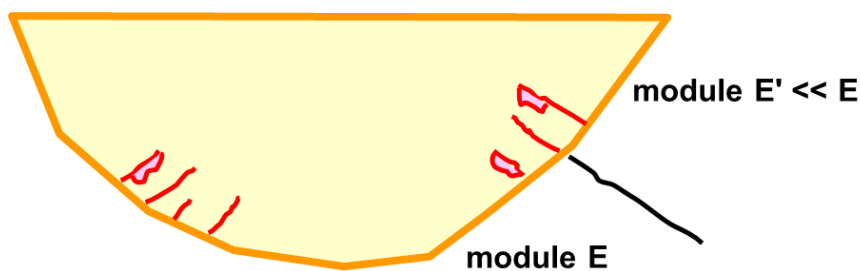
Fissuration par hétérogénéité des modules de fondation
